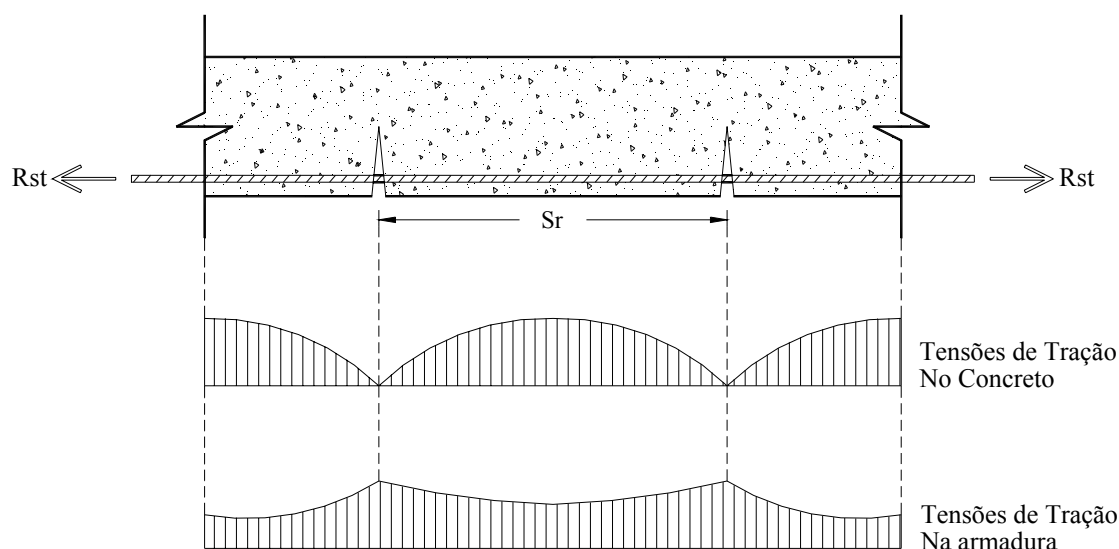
Tensões no concreto e na armadura entre duas seções fissuradas
